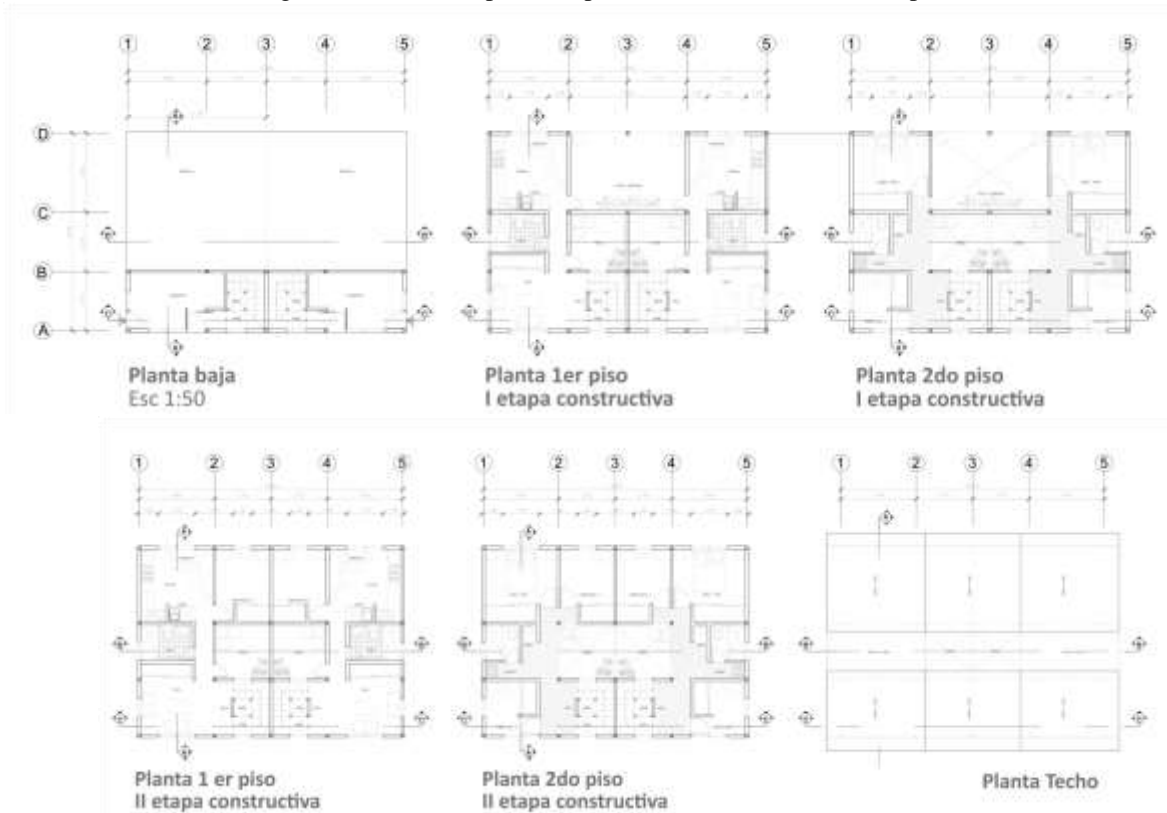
Plantas Propuesta Tipo B. Fuente: Elaboración Propia
